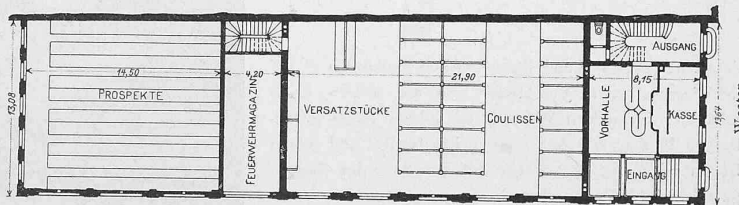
Grundriss des Theaterdekormations-Gebäudes. — Masstab 1 : 500.
